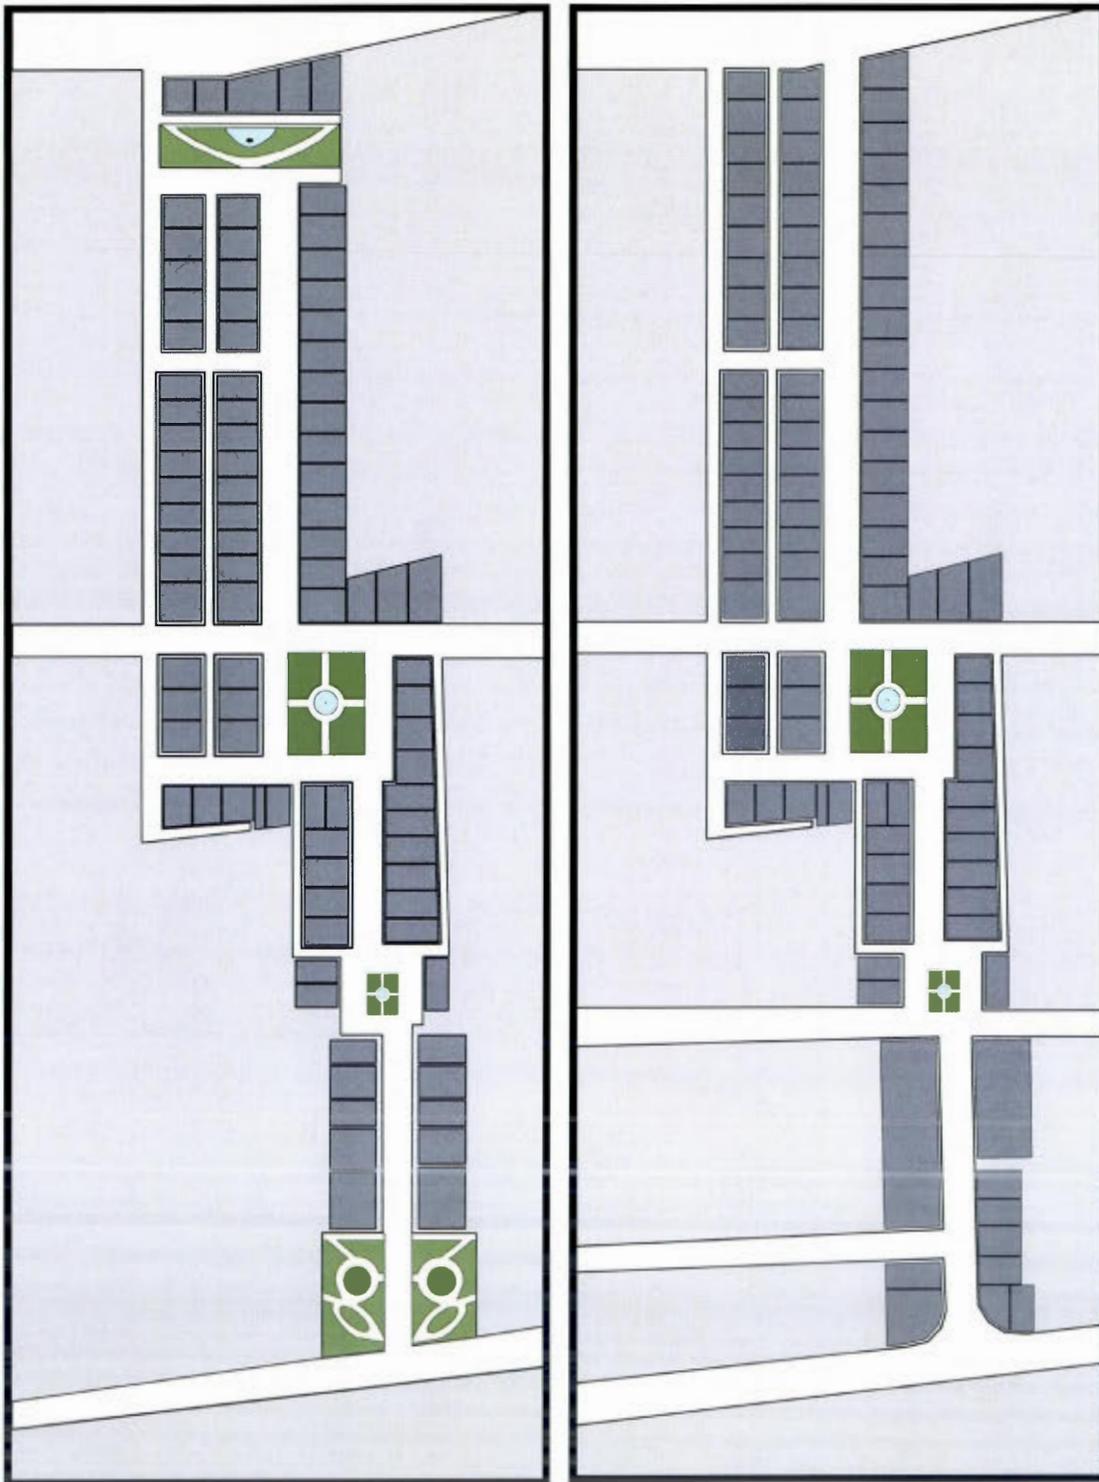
Plans des deux propositions de lotissement du plan Phillips, J. Cha.
